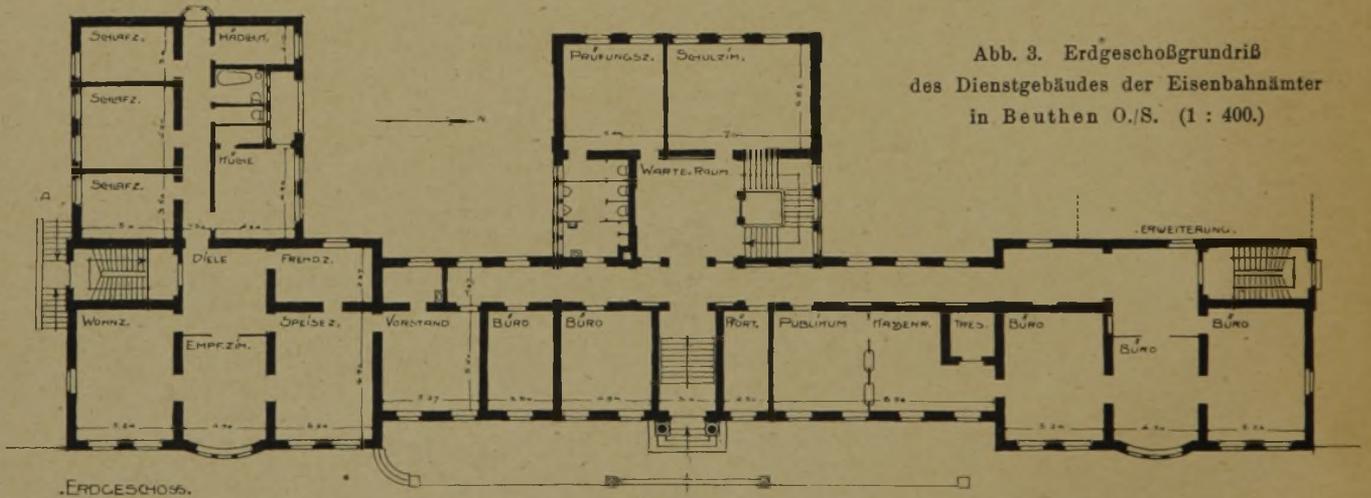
Erdgeschoßgrundriß des Dienstgebäudes der Eisenbahnämter in Beuthen O./S. (1 : 400.)
